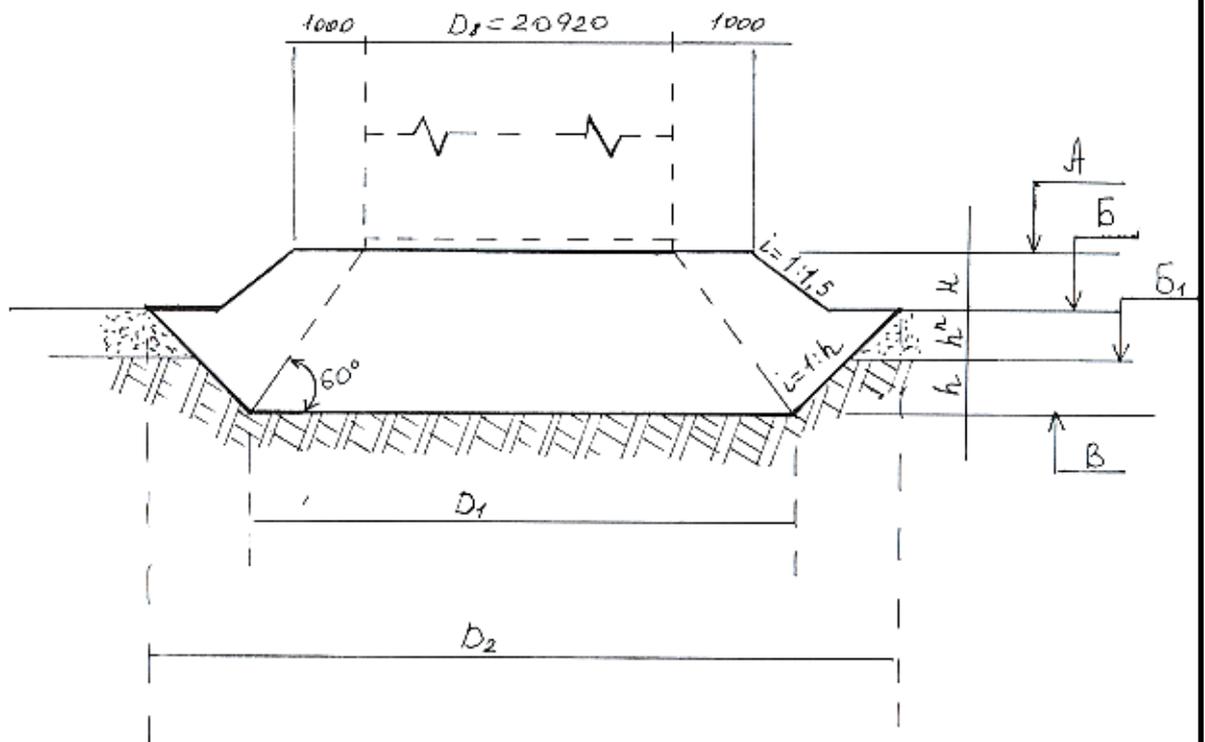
Принципиальное решение по фундаменту резервуара на подушке
